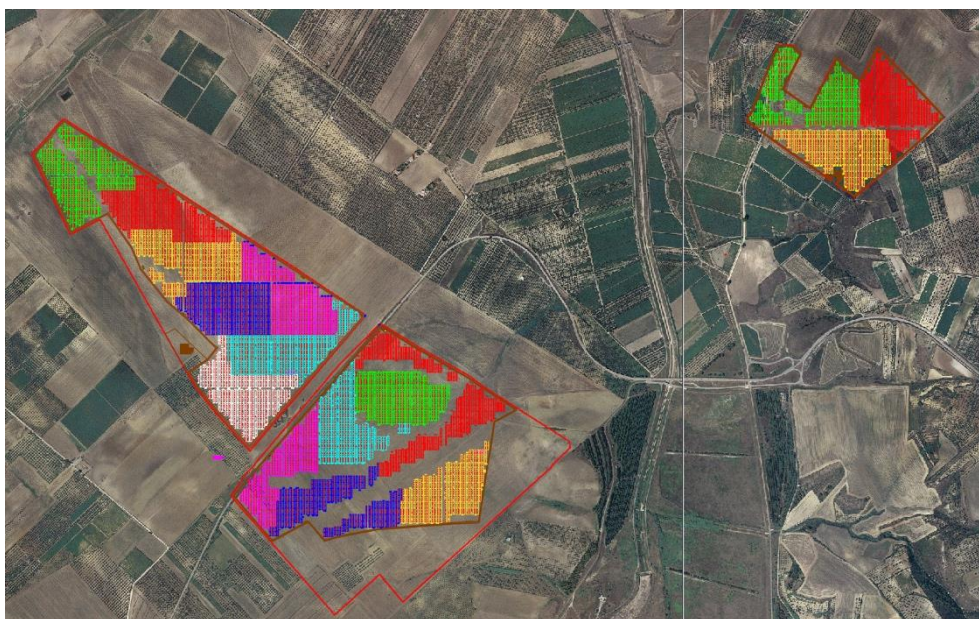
Planimetria generale dell'impianto fotovoltaico
